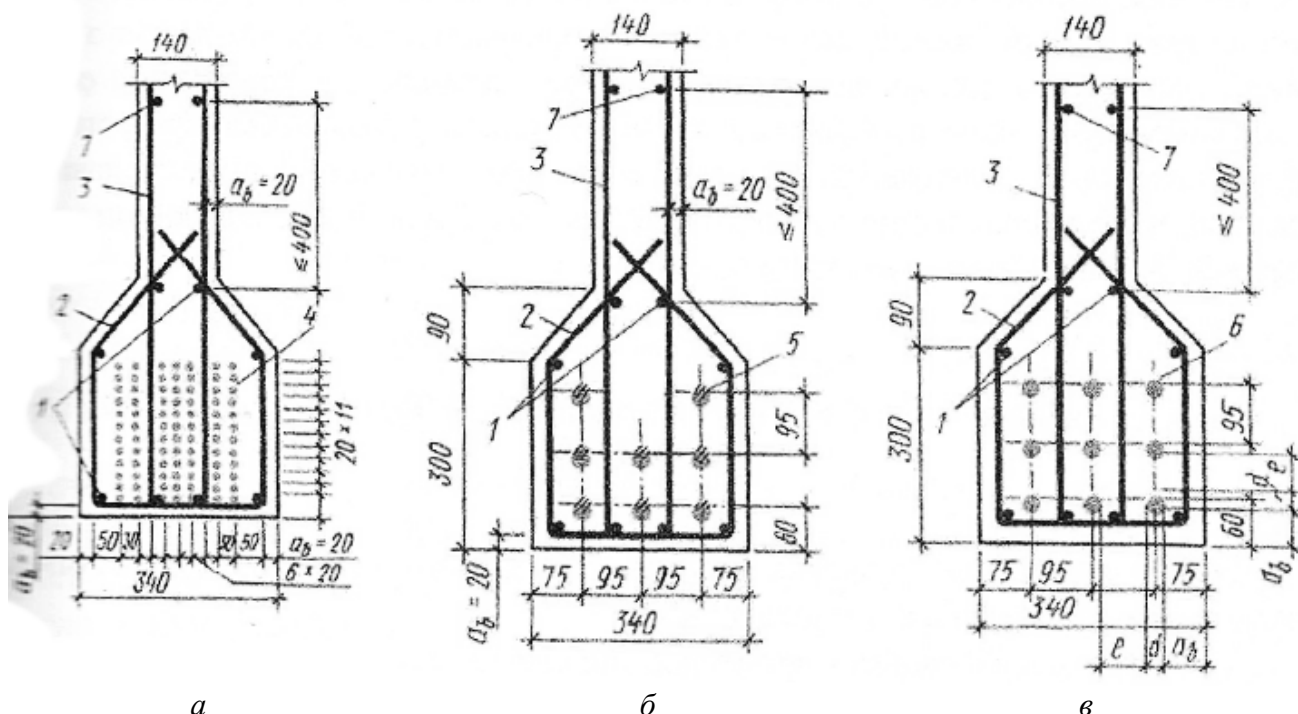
Способы армирования балки: *а* – проволокой; *б* – стержнями; *в* – канатами; 1 – продольная монтажная ненапрягаемая арматура; 2, 3 – хомуты; 4 – высокопрочная проволока; 5 – отдельные стержни; 6 – канаты; 7 – конструктивная арматура
